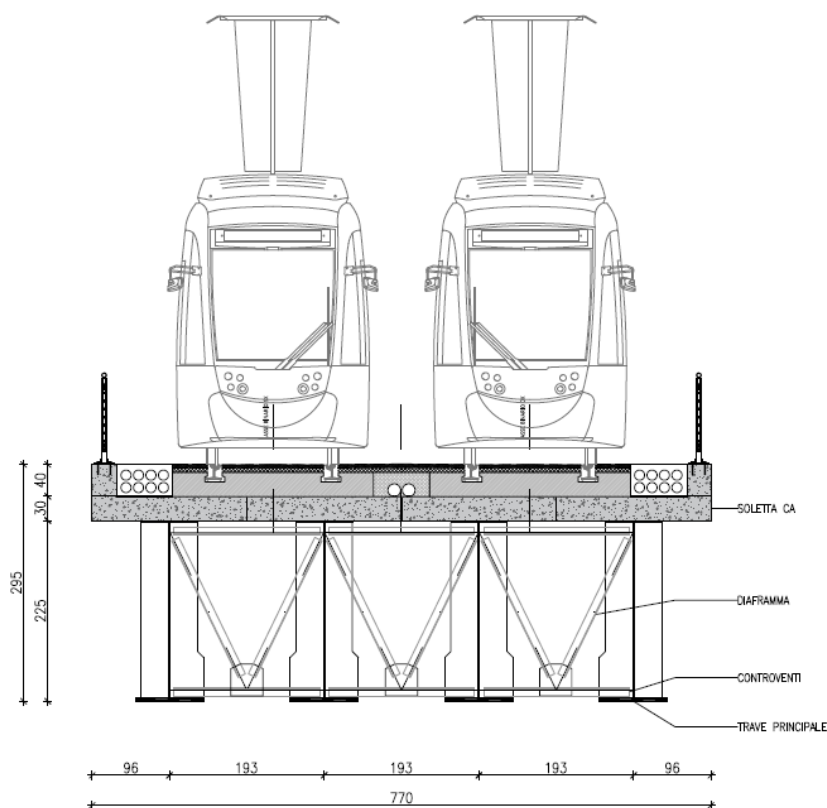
Sezione trasversale Nuovo Ponte sul Navile
